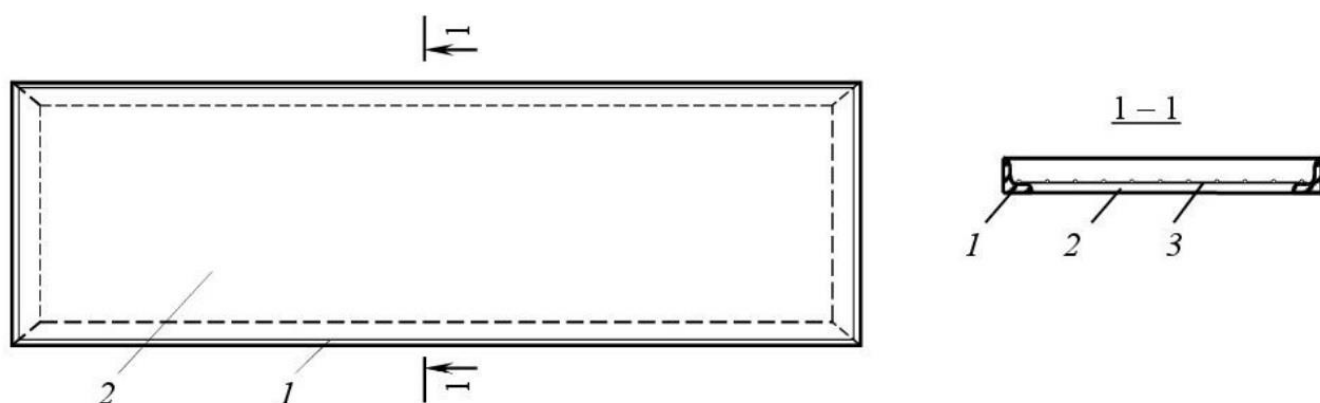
Збірна залізобетонна плита перекриття зі сталевим обрамленням:
